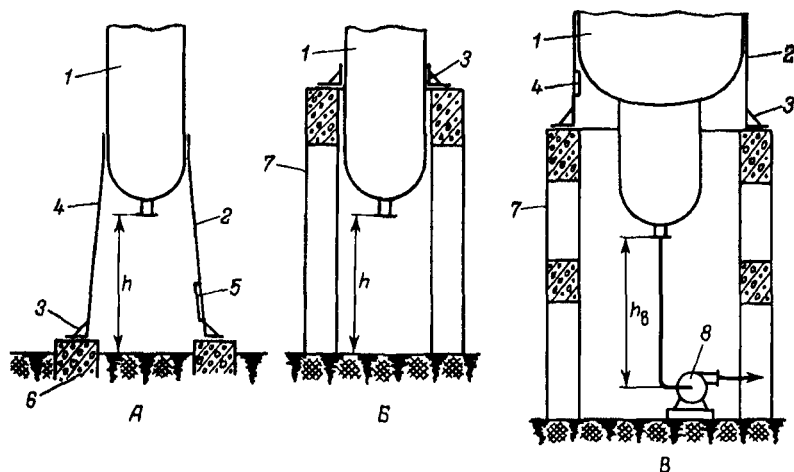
17 Варианты (А-В) установки колонн на постаменты и фундаменты
